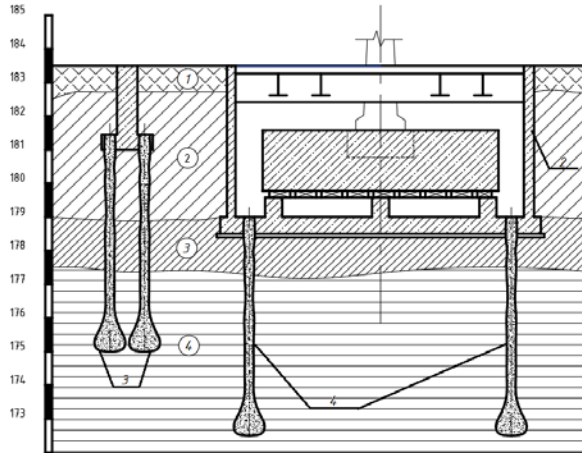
Схема усиления основания: 1 – фундамент каркаса здания; 2 – фундамент кузнечного молота; 3 – буринъекционные сваи ЭРТ (РИТ, ЭРСТ, ФОРСТ) усиления оснований фундаментов каркаса; 4 – буринъекционные сваи ЭРТ усиления оснований фундаментов молота
